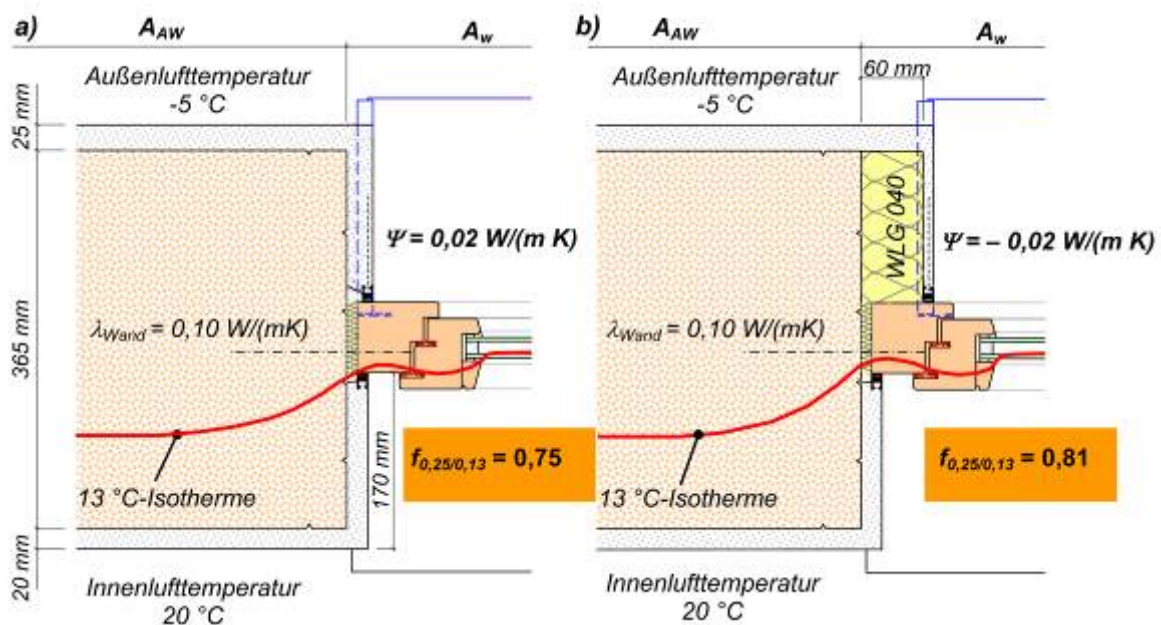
Fensteranschluss an monolithisches Mauerwerk (a. übliche Ausbildung, b. wärmetechnisch verbesserte Ausbildung mit Leibungsdämmung außen)
